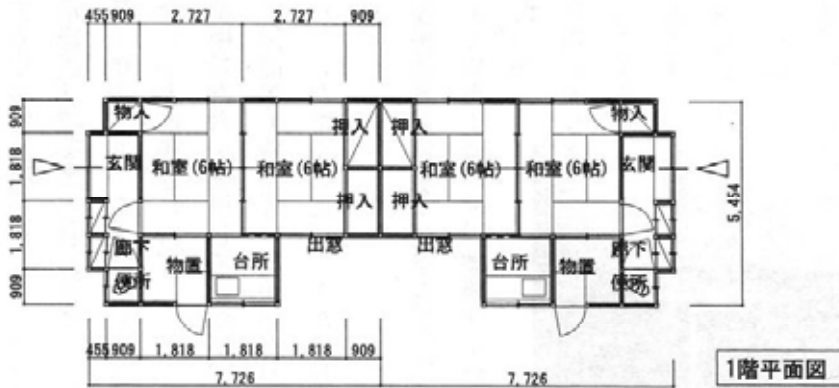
海軍航空廠工員宿舎立面図・平面図 (1/100)
